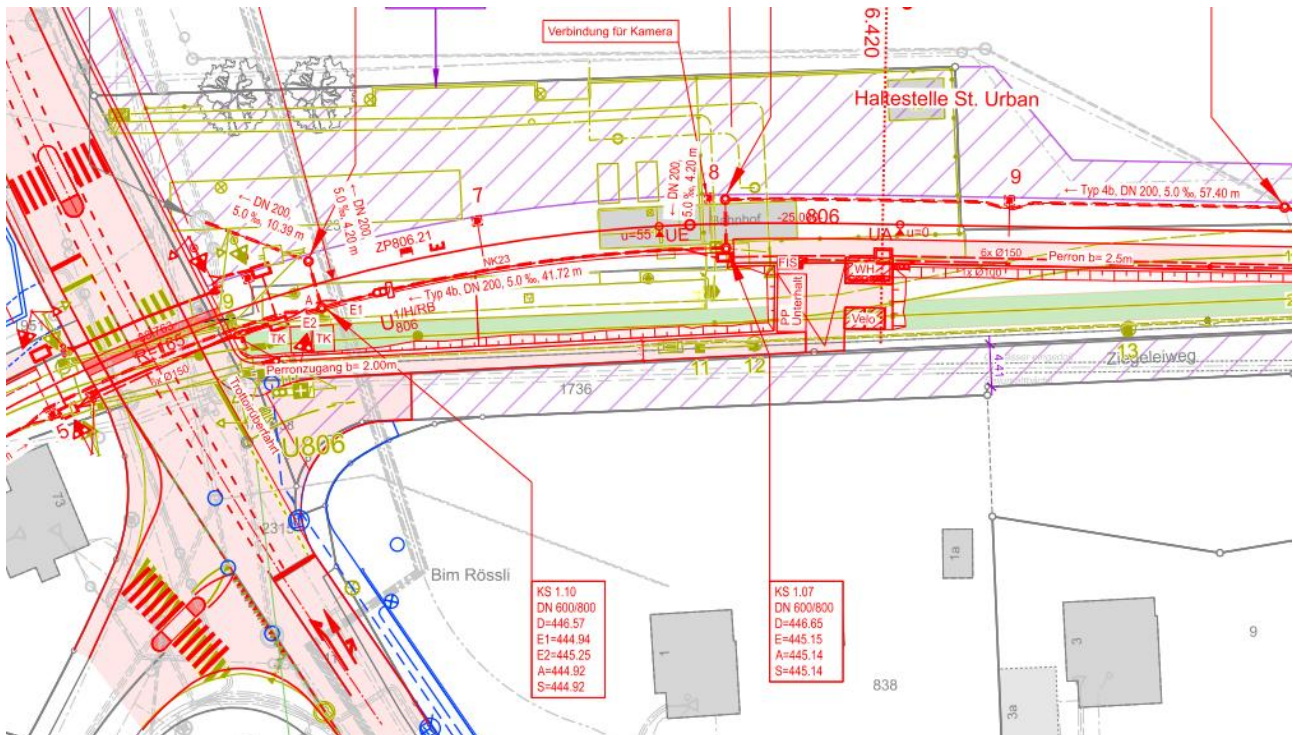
Planausschnitt Entwurf Vorprojektierung neue Haltestelle und Trottoirüberfahrt
